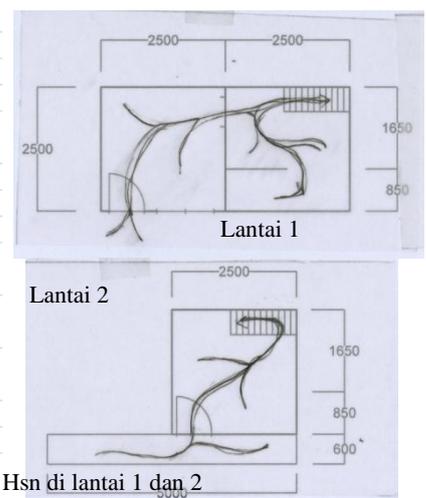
Denah lantai 1 rumah bu Hsn
